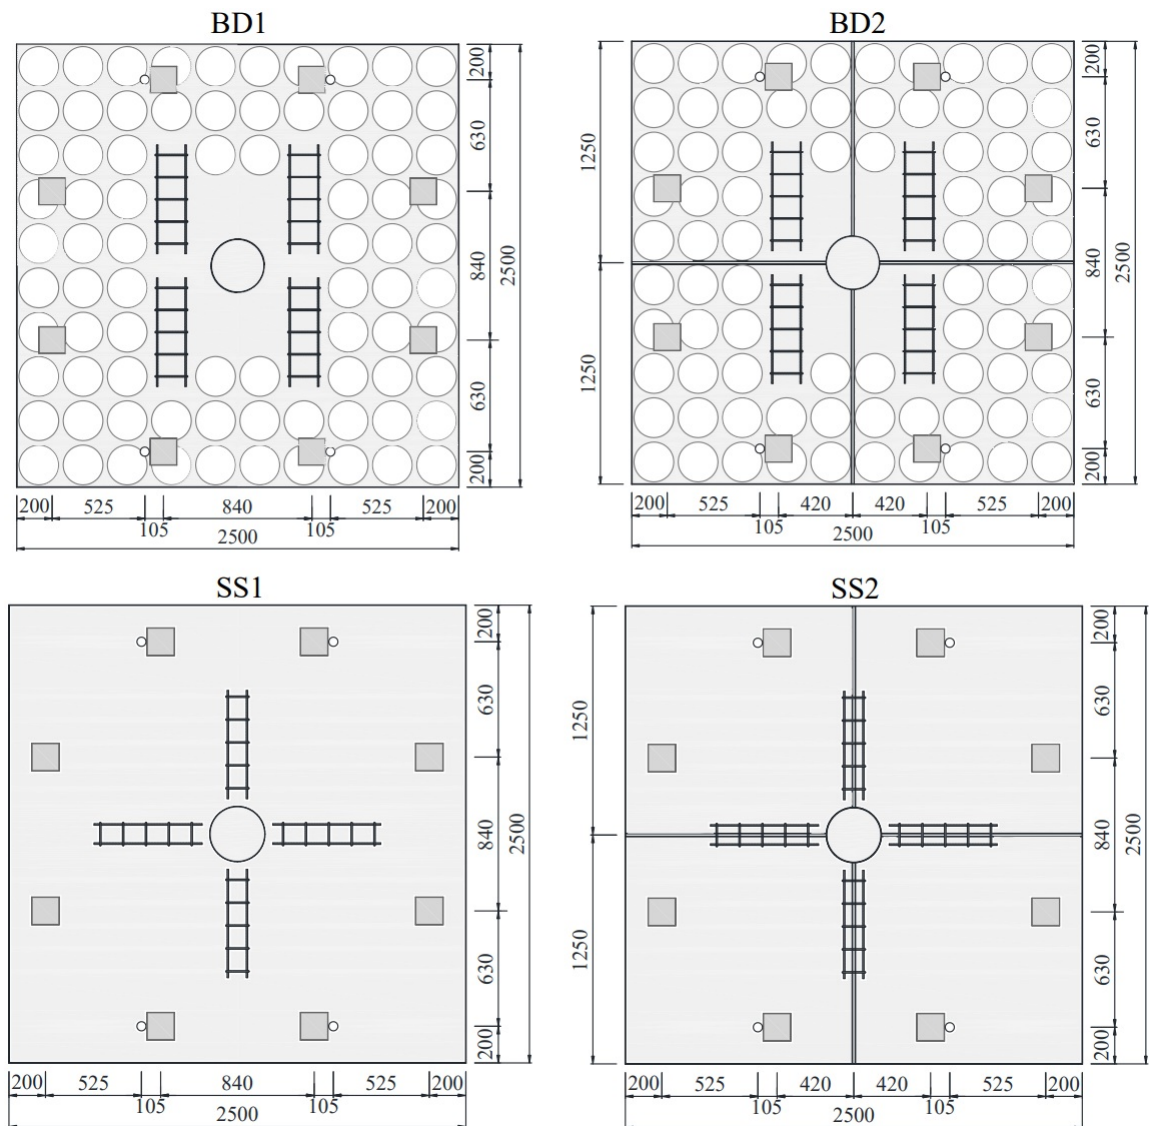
Lajes da segunda série de concretagem (dimensões em mm) (fonte: Nicácio (2018))
